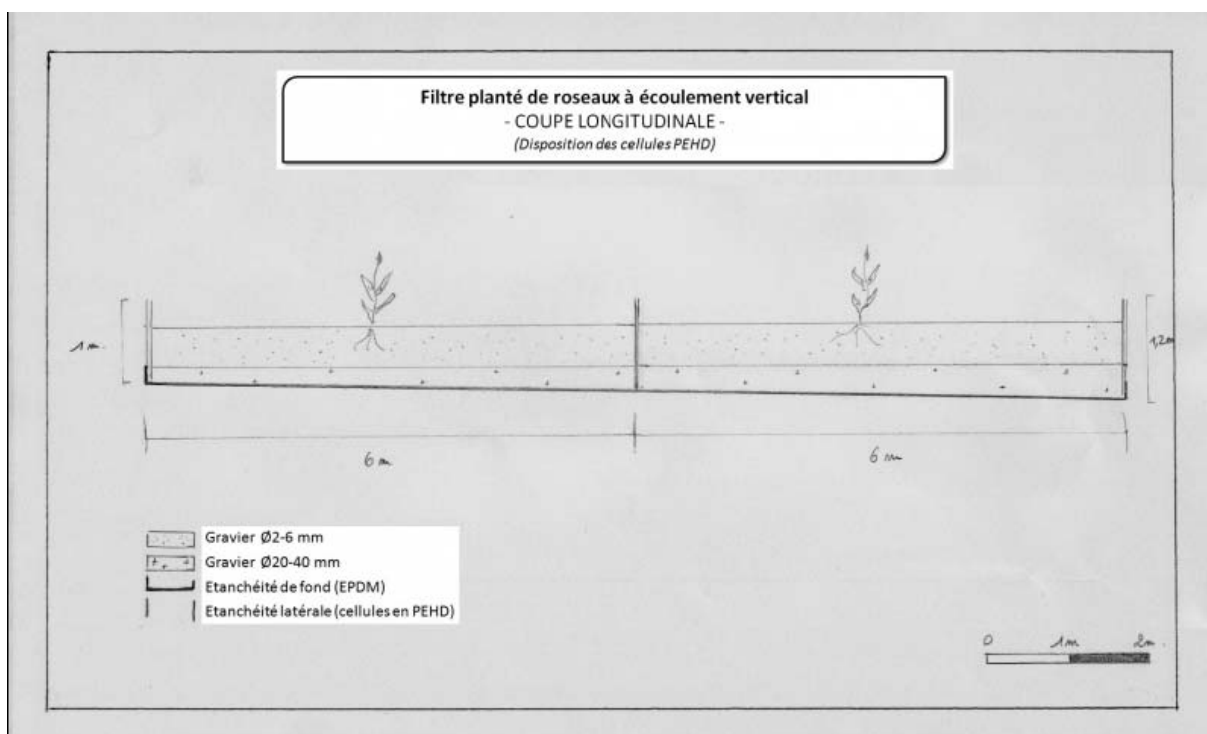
Coupe longitudinale du filtre planté de roseaux à écoulement vertical :
